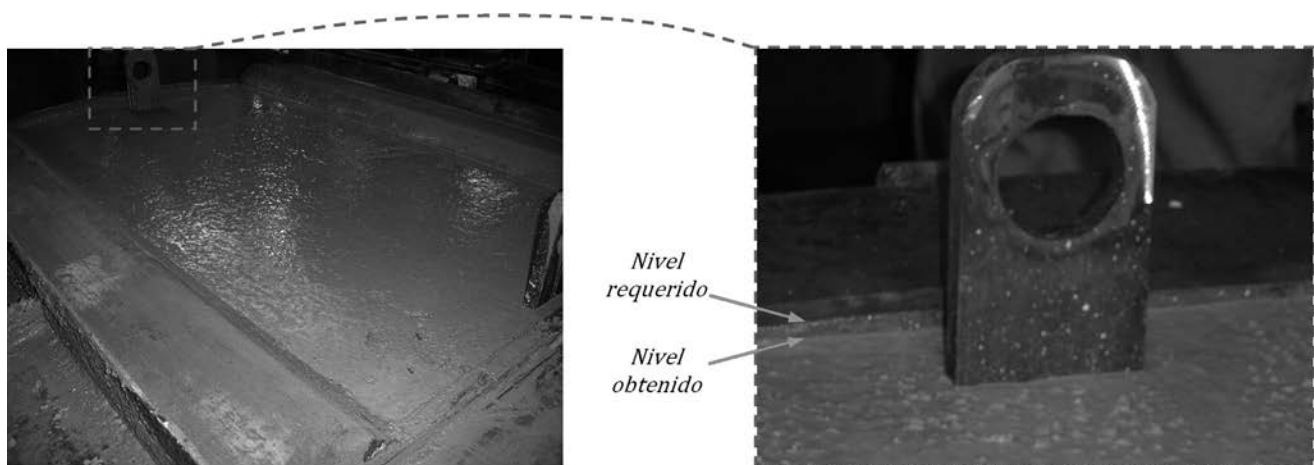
Vista de las tolerancias en la geometría del molde y dovela con HAC
